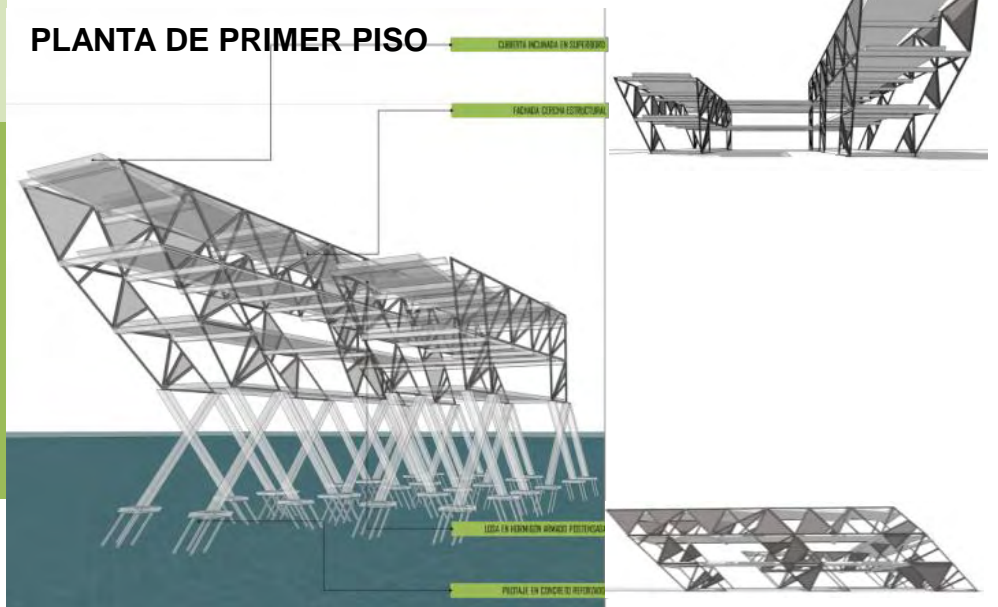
Propuesta 3ds Estructural del Proyecto
